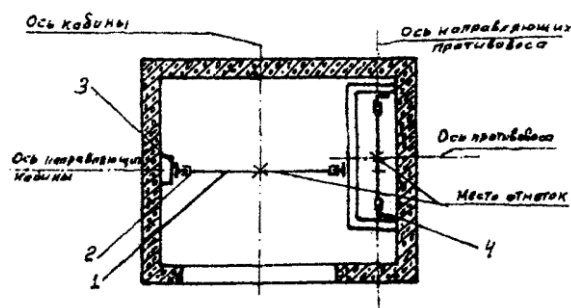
Установка осевых струн для выверки лебедок (противовес сбоку кабины):
